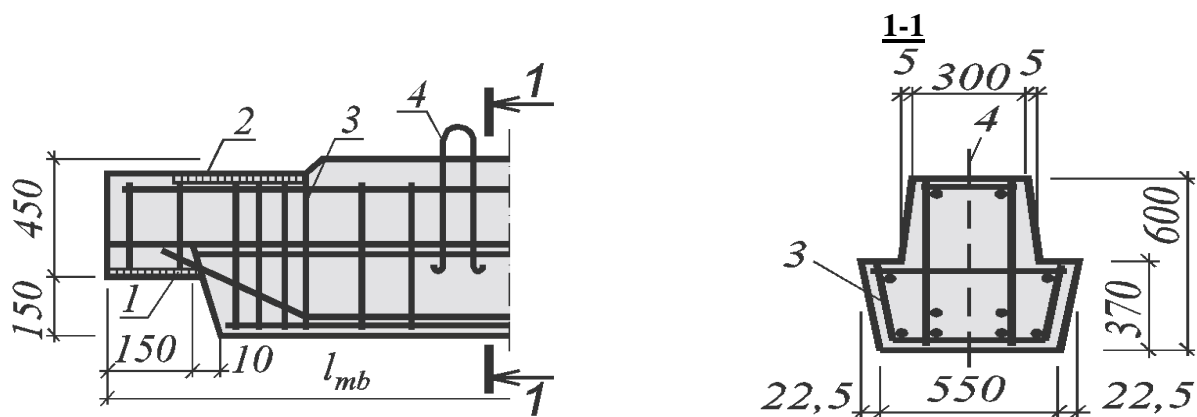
Конструкція ригеля з підрізкою на опорі: 1 – опорна закладна деталь для зварювання з консоллю колони; 2 – закладна деталь для монтажного приварювання до колони; 3 – просторовий арматурний каркас; 4 – монтажні петлі
